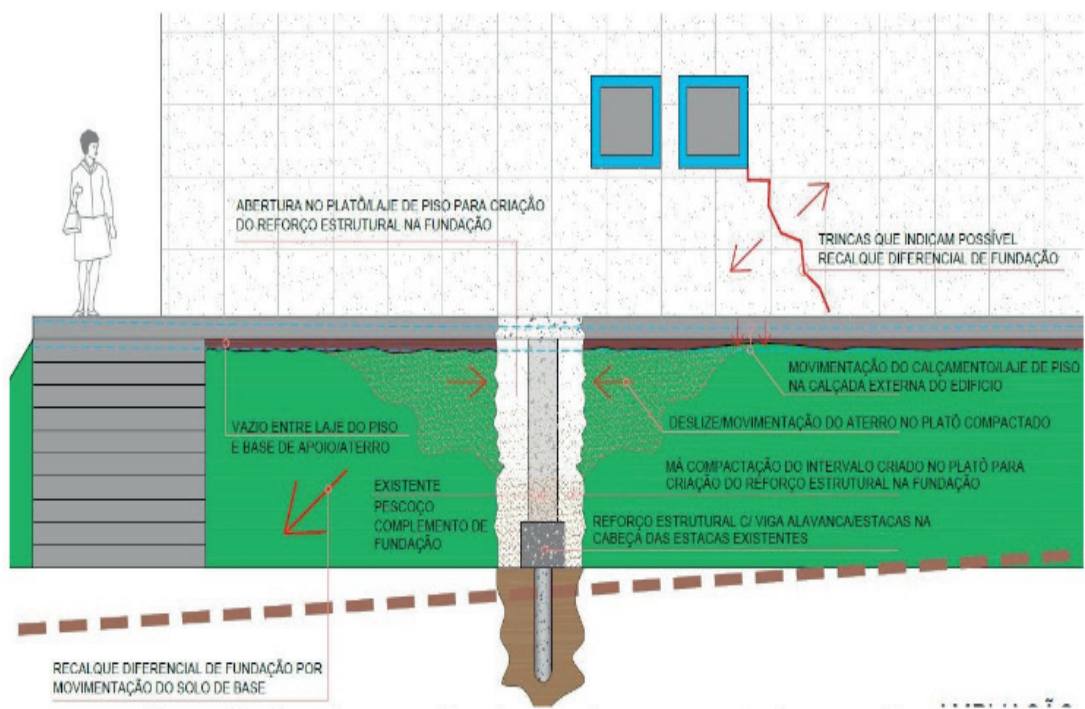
Croqui esquemático da viga alavanca executada como reforço.
